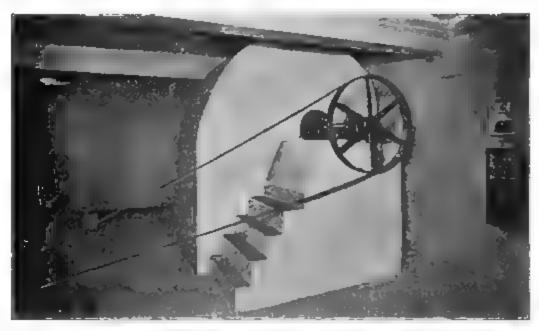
Zentrifugalventilator im Betongehause im Realgymnasium zu Plauen i. Vogtl
